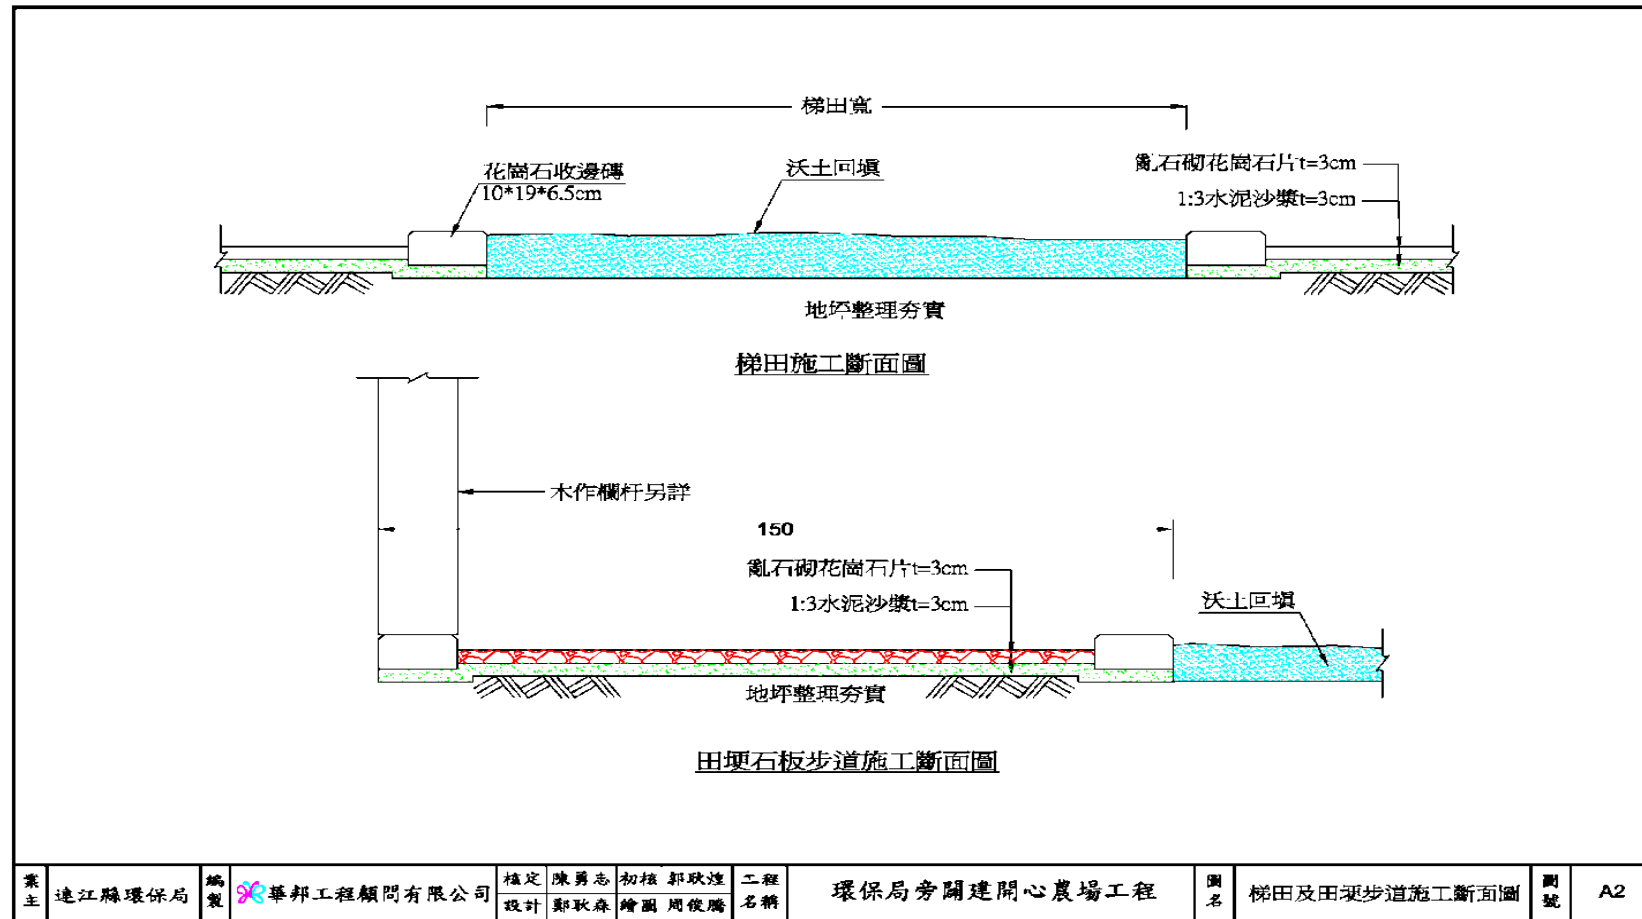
低碳環保觀光教育園區開心農場改造示意圖-梯田及田埂步道施工斷面圖
